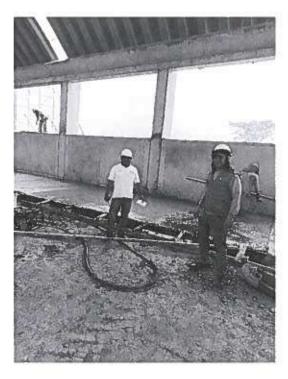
Se verifica el vaciado de concreto para las losas de concreto del piso del bloque N.º 16.
